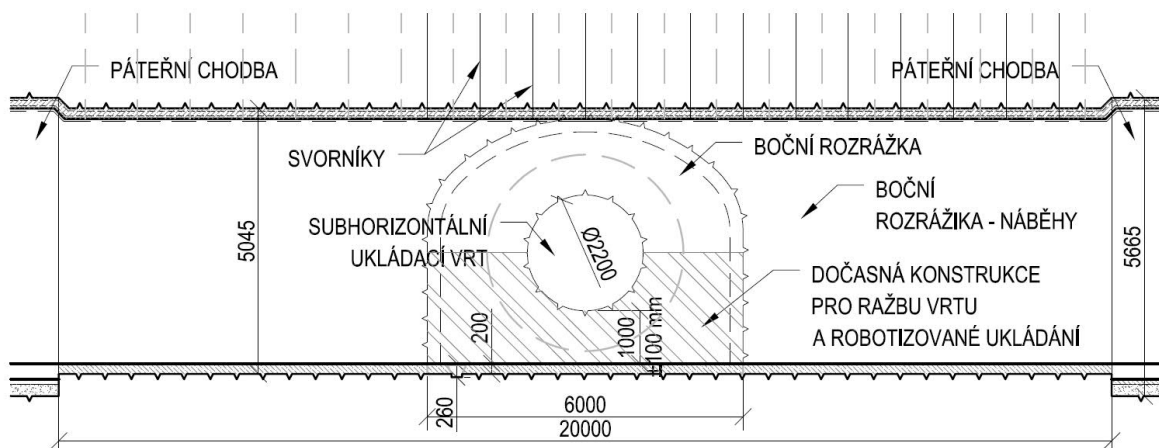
Půdorysné schéma ukládání – varianta D3 – HU, M
